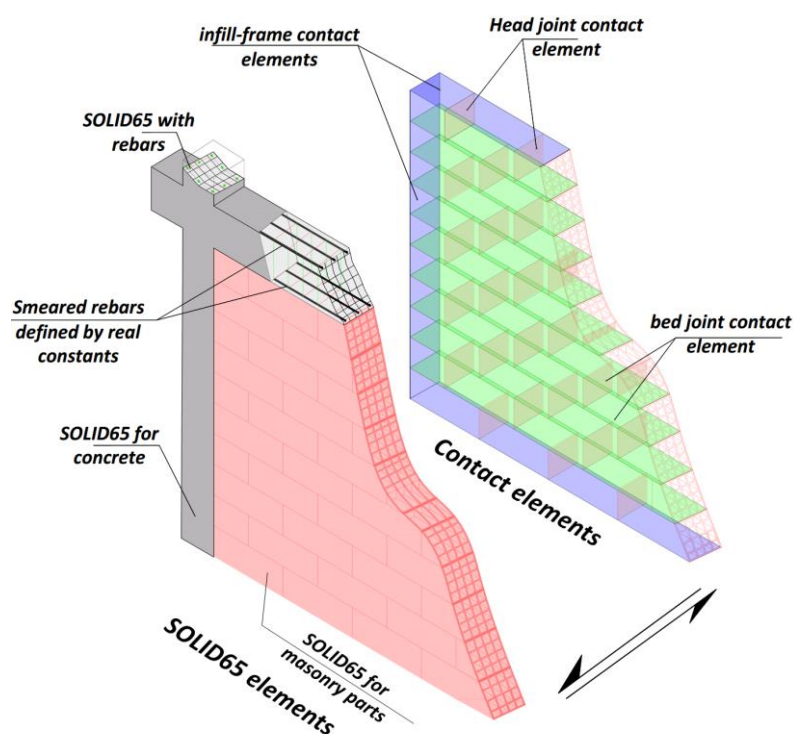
Esquema geral da modelação numérica por elementos finitos refinados para pórticos de betão armado com painéis de enchimento em alvenaria (ANSYS,2012)
